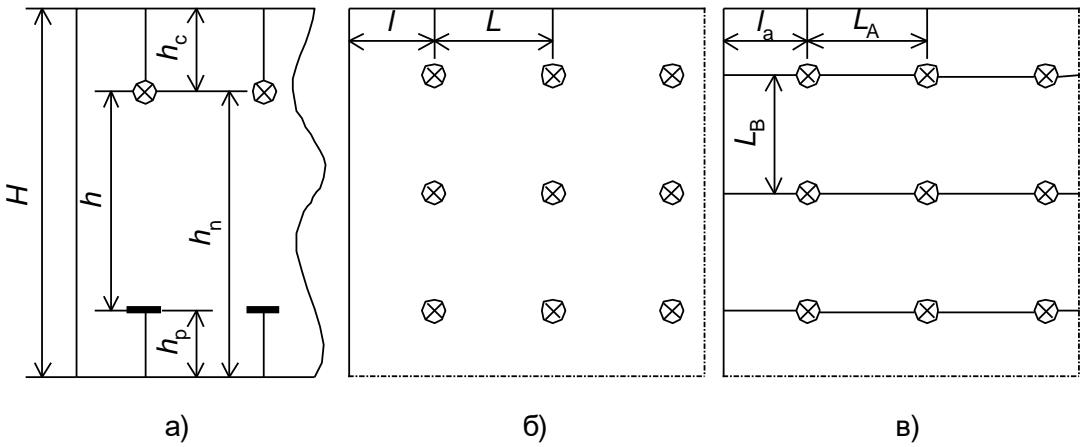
Схемы расположения светильников: в разрезе - а); плане - б) и в).
